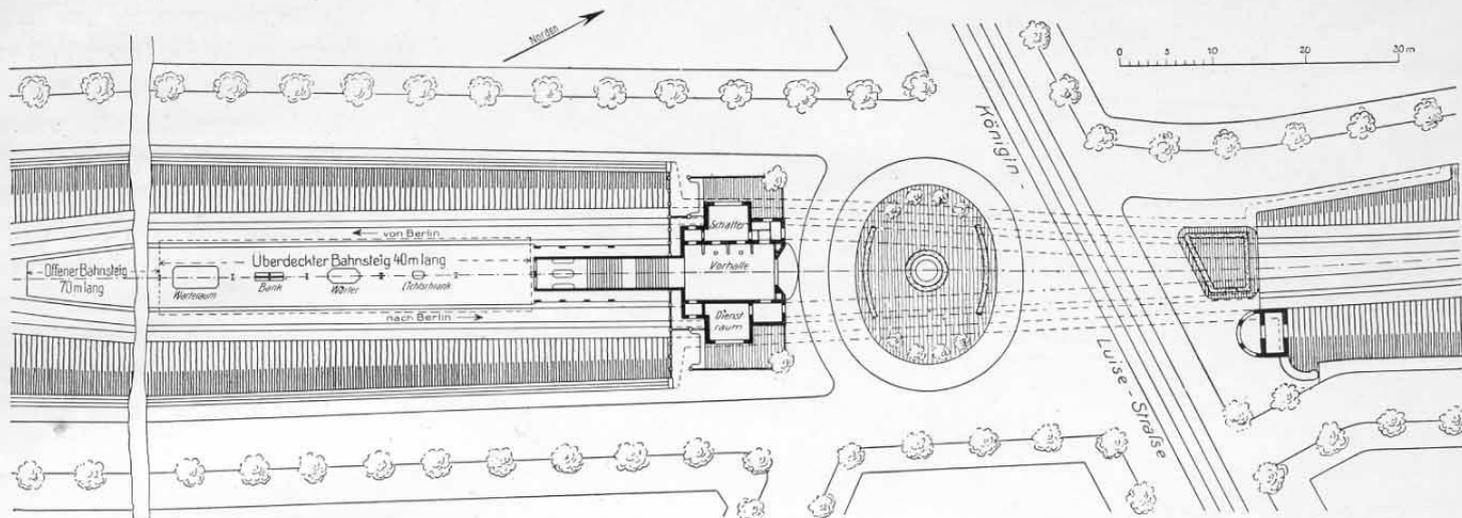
Lageplan des Bahnhofs Dahlem-Dorf.
